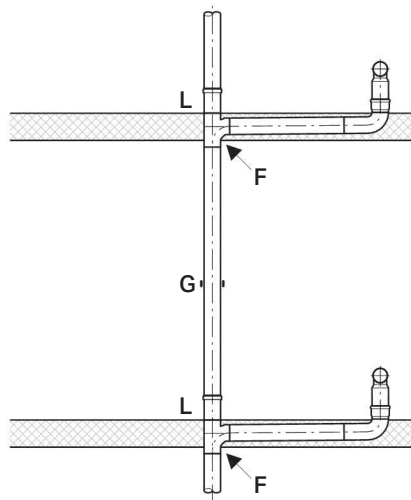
Beispiel A: Fallstrang mit Anschlussleitungen und einbetonierten Abzweiger als Fixpunkt
